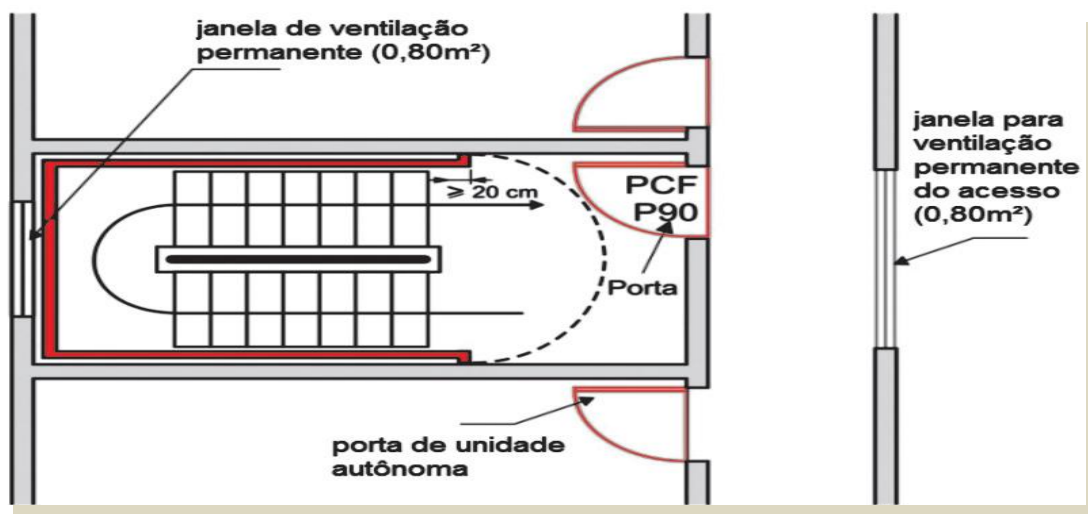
Ventilação da escada enclausurada protegida e seu acesso
